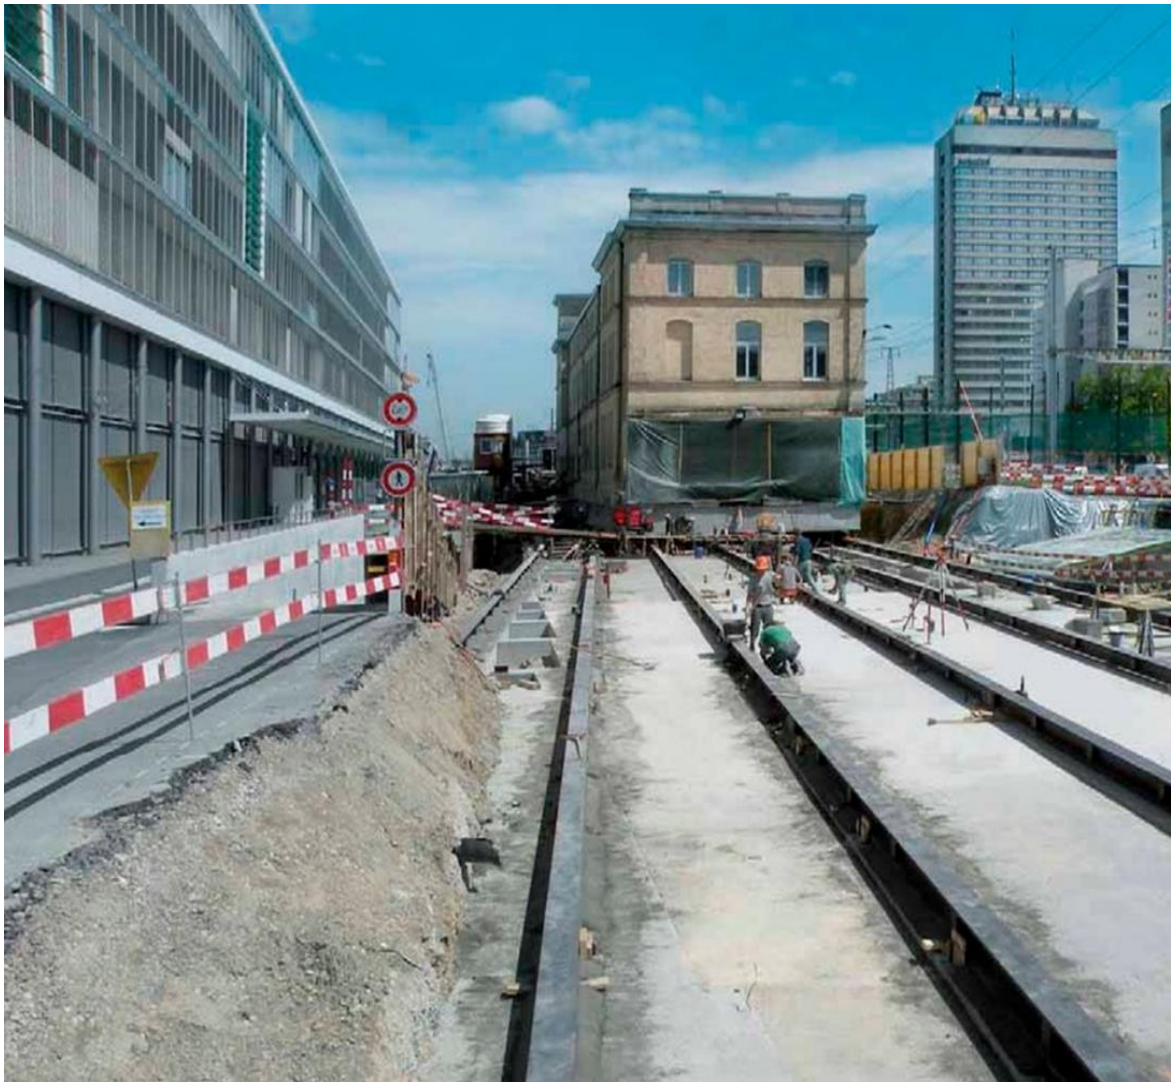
, Carriles sobre la losa de cimentación en el emplazamiento nuevo
